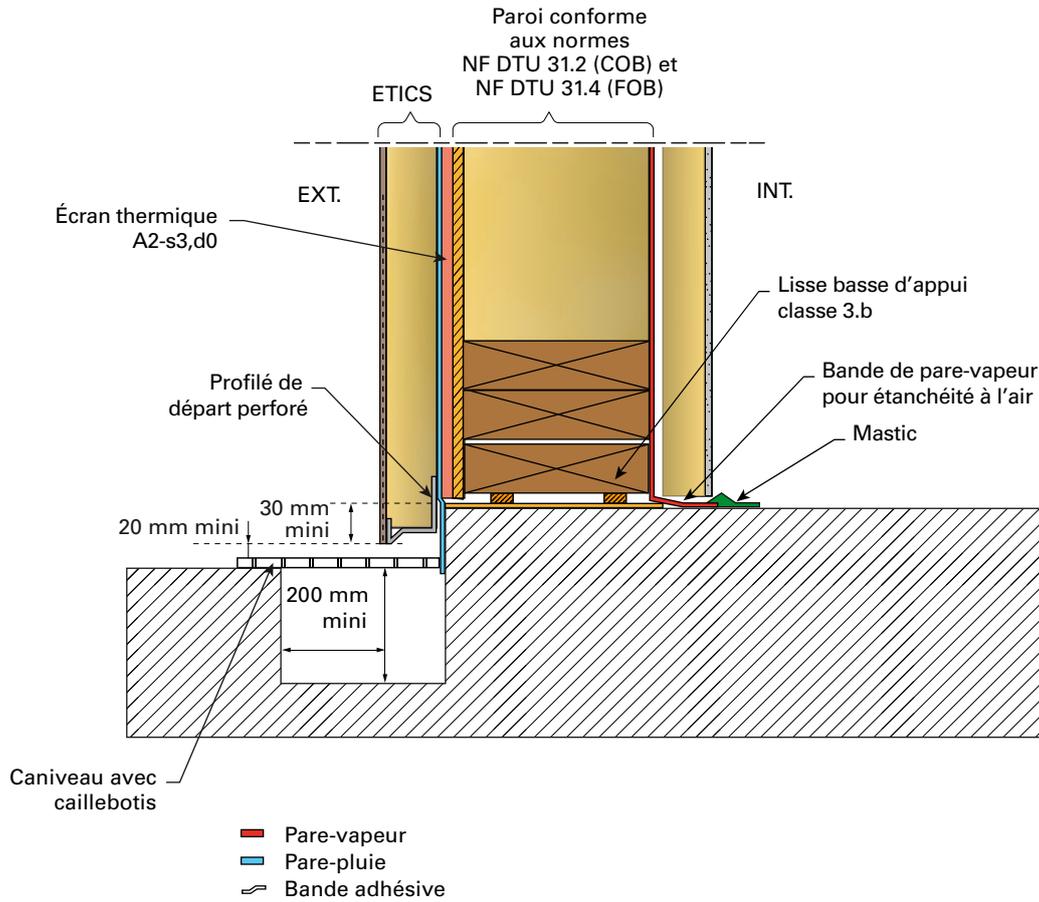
Exemple de pied de façade en présence d'un caniveau extérieur avec pare-pluie souple
